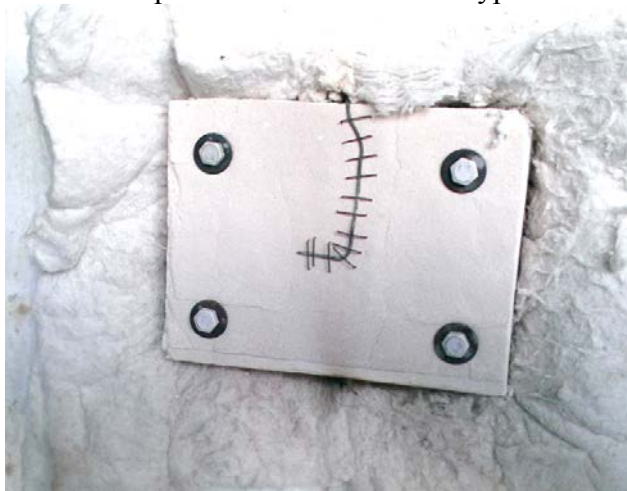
Общий вид испытаний с конструктивной огнезащитой
